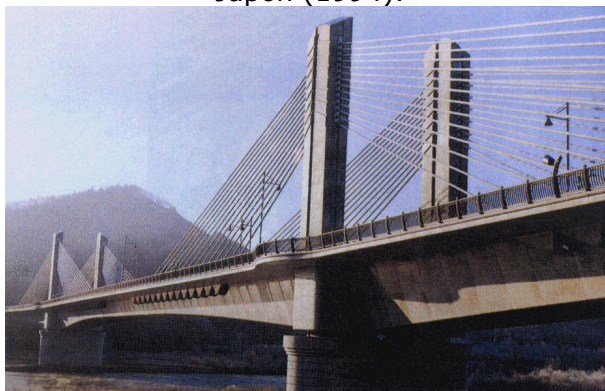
Puente de hormigón Tsukuhara, Japón (1997)
